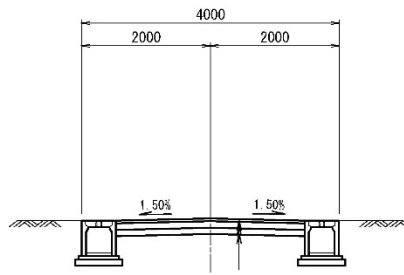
(10) 標準断面图 (特殊道路 幅員 4.0m)
